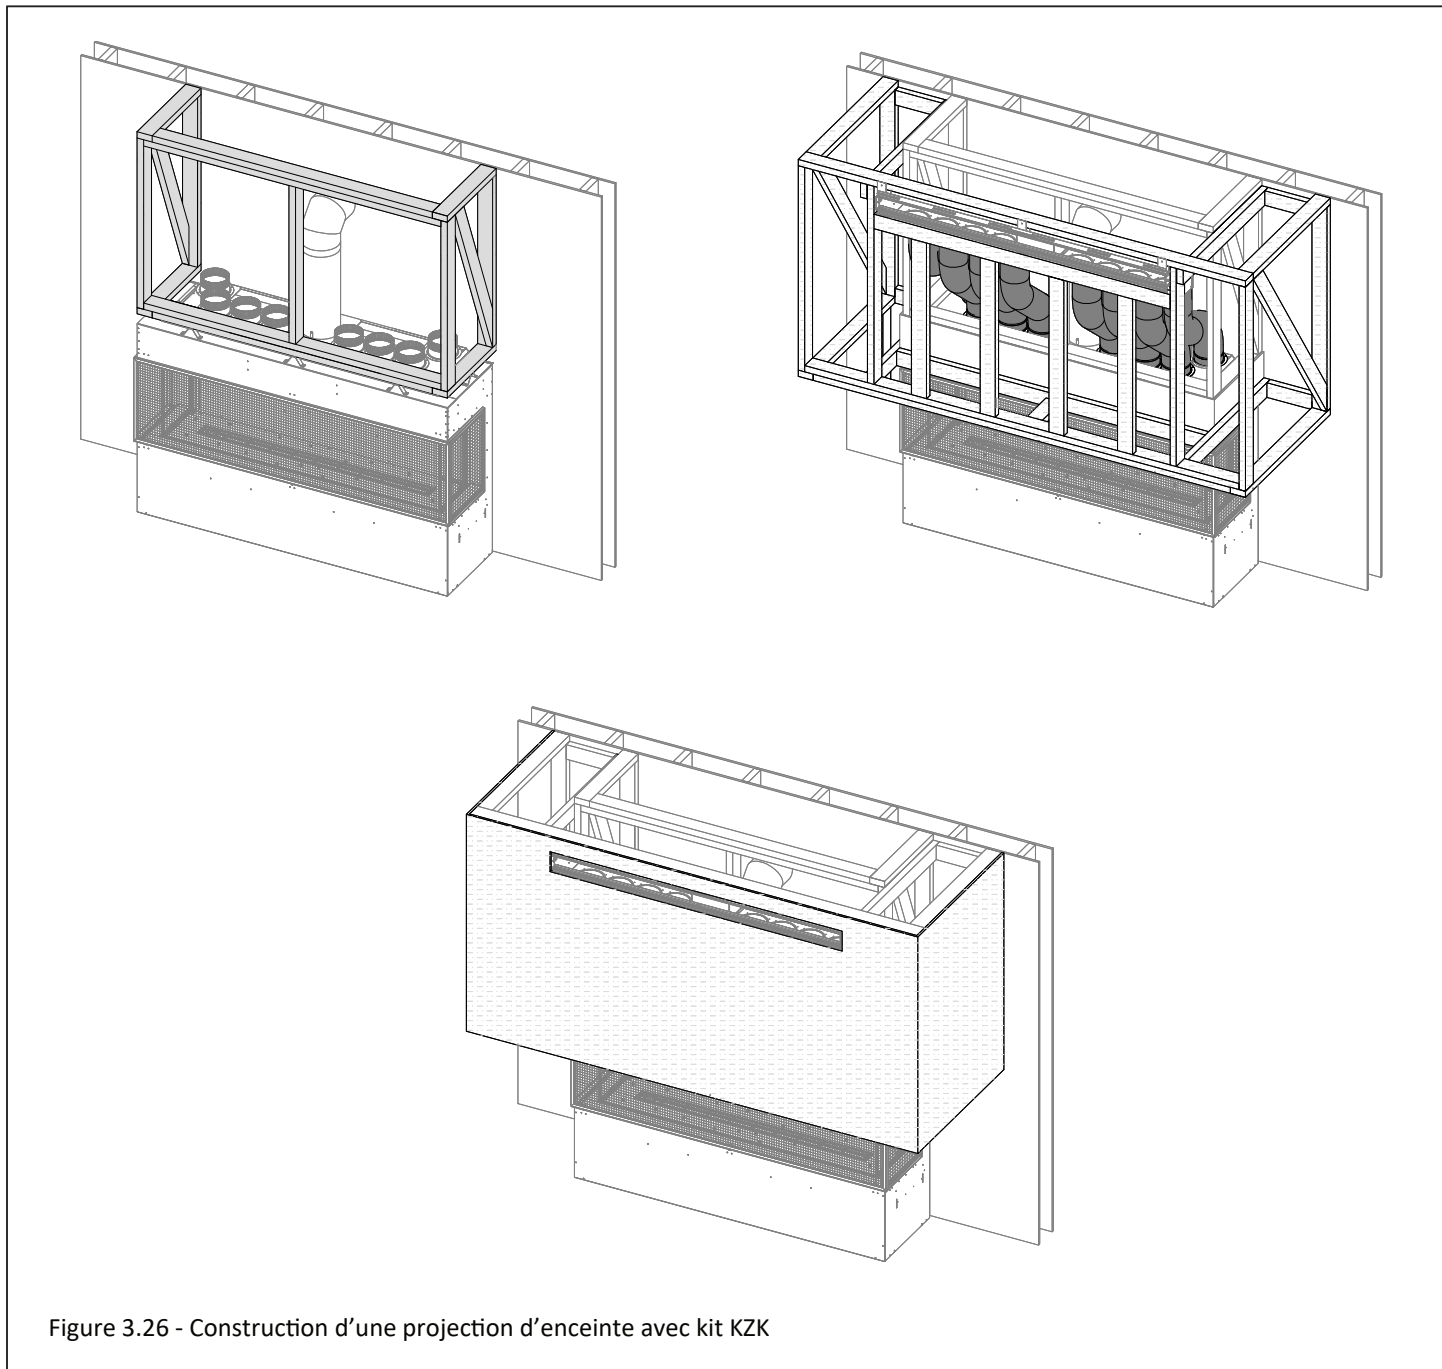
Construction d'une projection d'enceinte avec kit KZK
